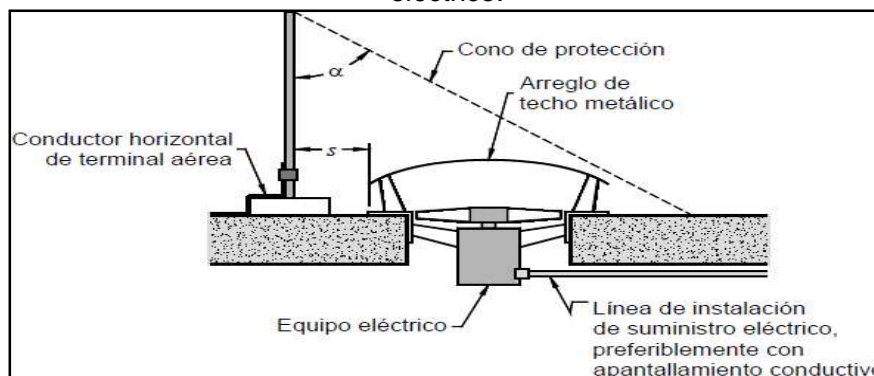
Posicionamiento de un SIPRA en techo plano y con accesorios en el techo
